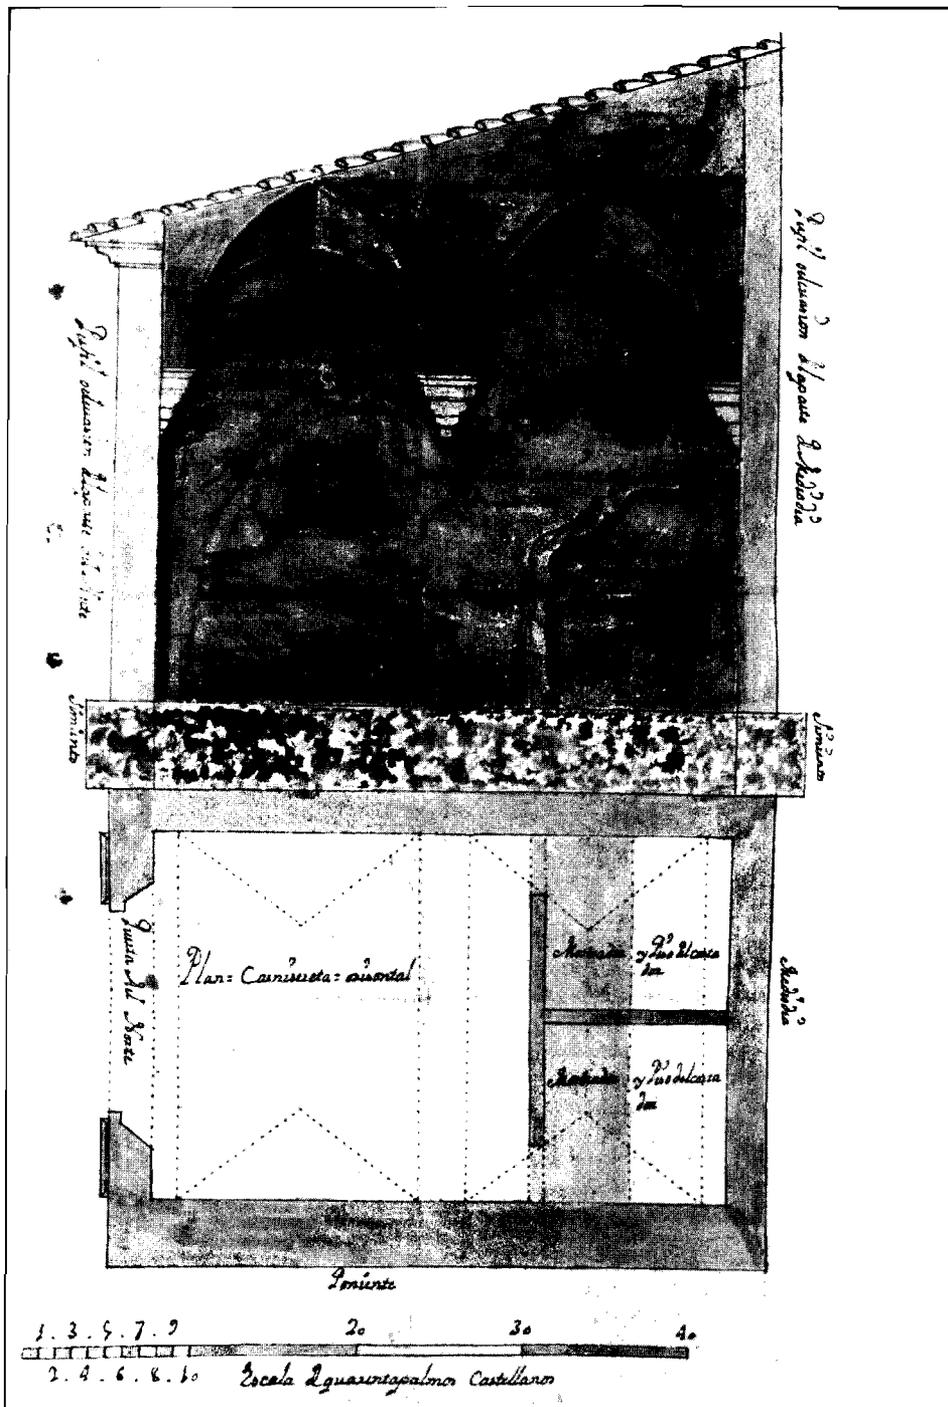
Carnicería de San Antolín. Planta y corte transversal del alzado
